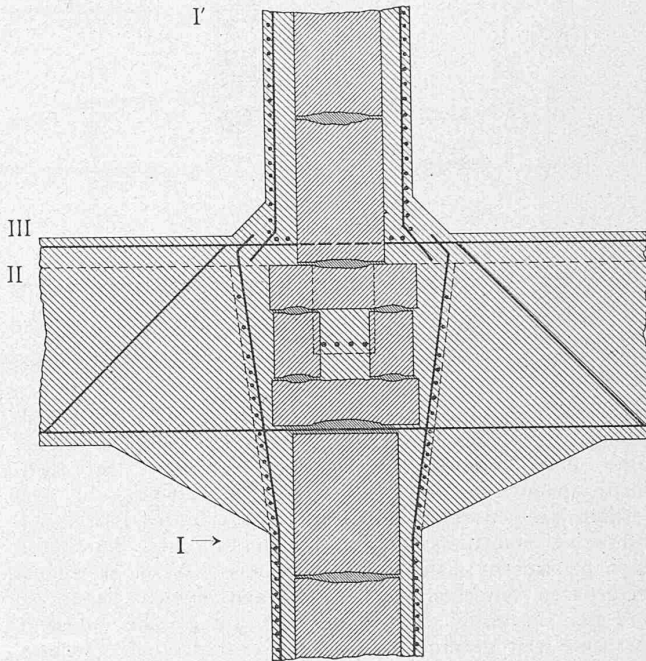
Umschnürte Betonsäulen mit Steinkernen (Schema).
